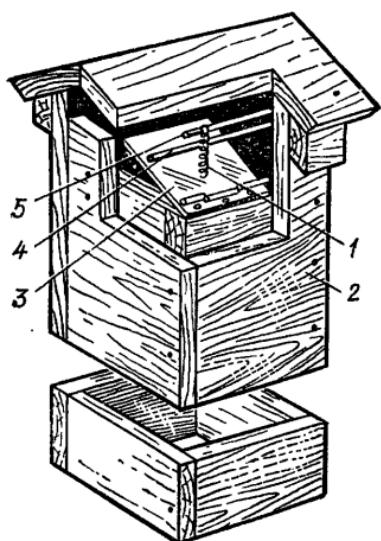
Защитное устройство ЗУ из толстых досок (устанавливается на вытяжных вентиляционных каналах или на воздухозаборных каналах чистой вентиляции):
